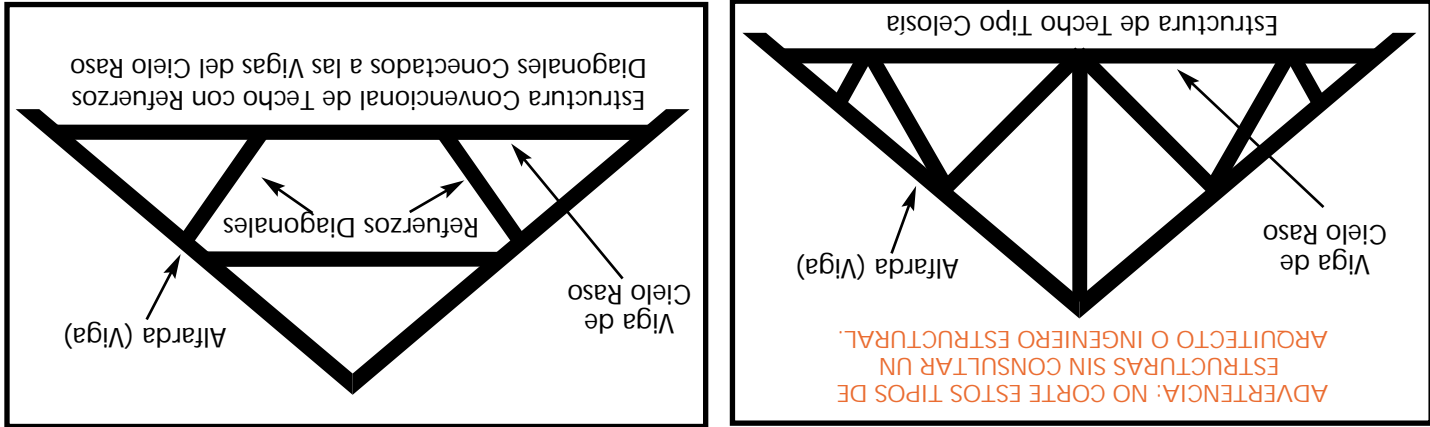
Estructura de techo tipo celosía y estructura convencional de techo con refuerzos diagonales conectados a las vigas del cielo raso.
